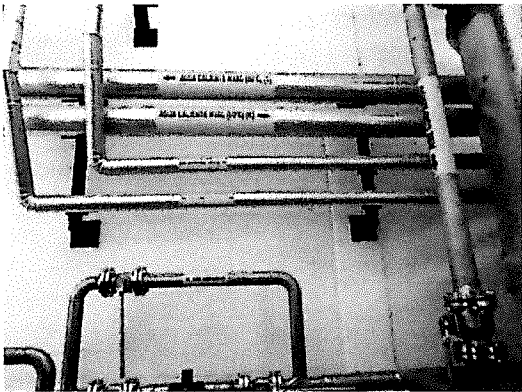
Distribución de las instalaciones que se proponen dentro de la Planta
